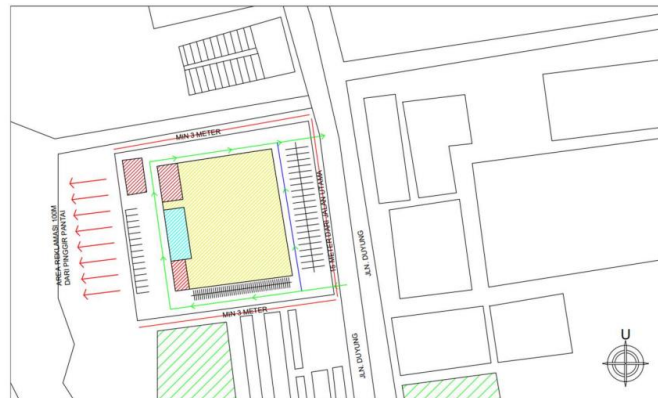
Konsep aplikasi penerapan ruang dalam bangunan
